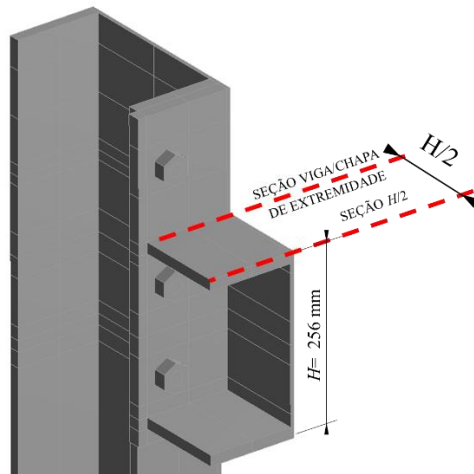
Posição das seções transversais horizontais da mesa da viga.
